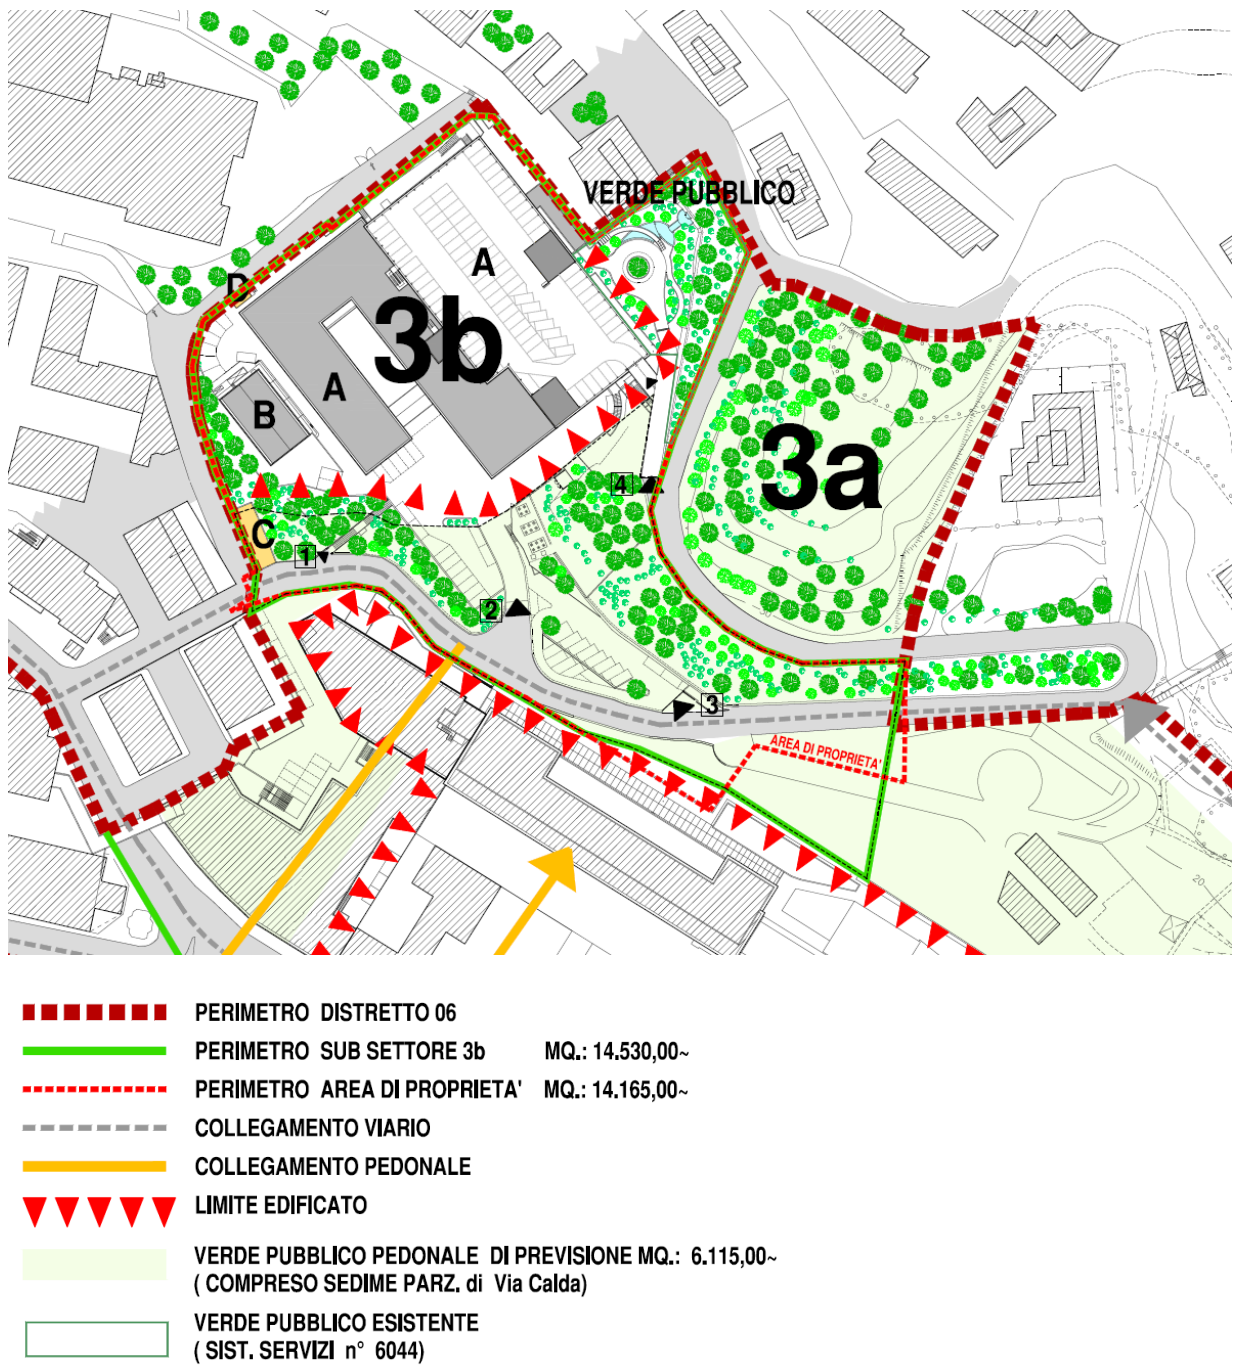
Planimetria del P.U.O. (stralcio Tavola 03 di Progetto)
